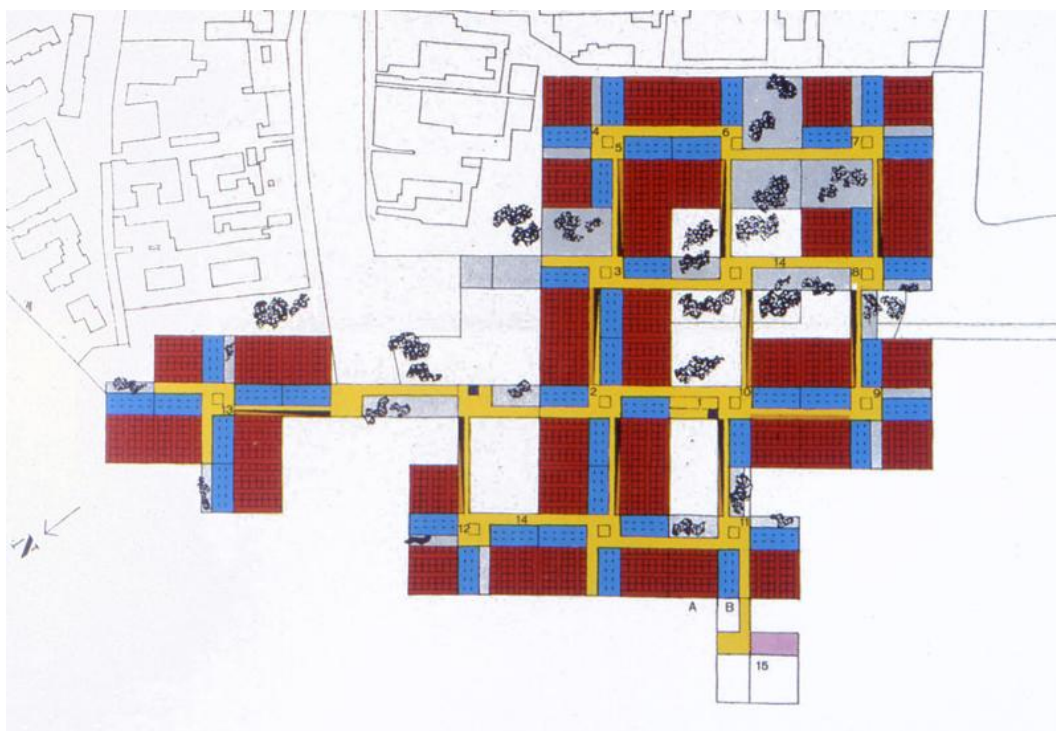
Le Corbusier, Hospital de Veneza, 1964, planta do 3º pavimento.
